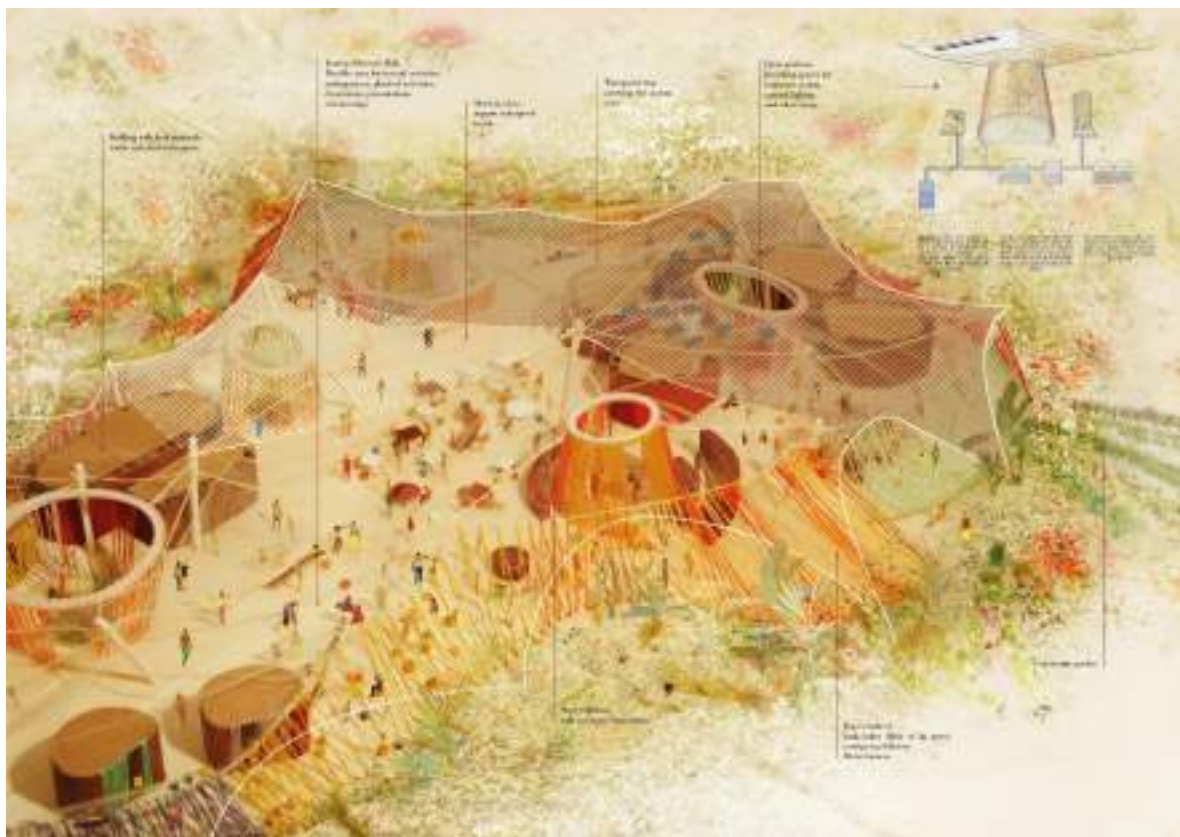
Planta baixa do projeto #resistenceintension setorizada.
